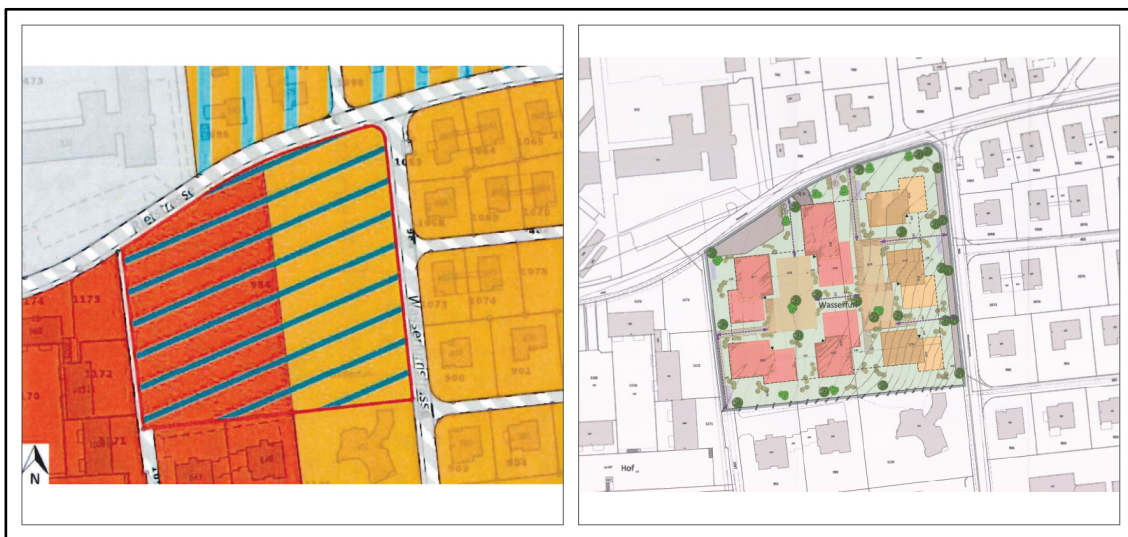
GP "Wasserfurri", Zonenplan (links) und Gestaltungsplan (rechts) (BHAtteam Ingenieure AG, 2018)
